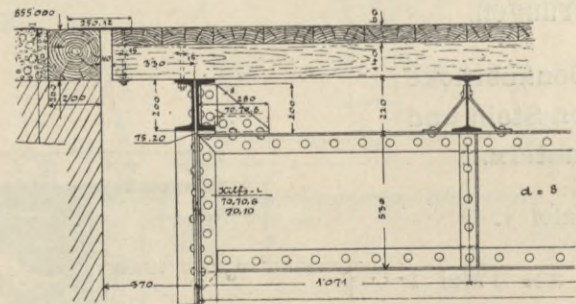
Bewegliches Ende der Brücke. 1 : 30.
